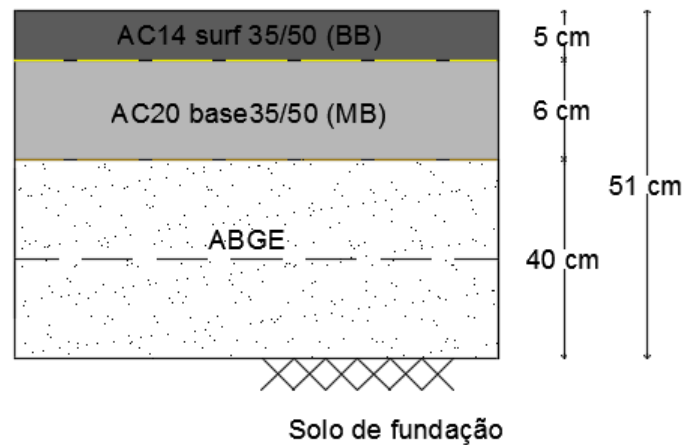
Estrutura do pavimento do prolongamento da Rua Igreja do Paraíso
